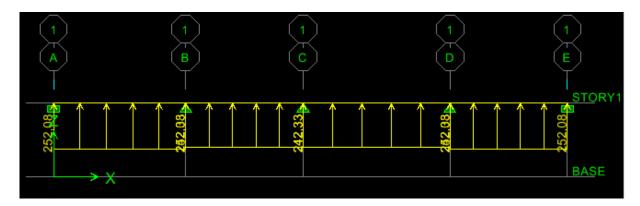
Schéma statique de la nervure ELS (sens transversal).
